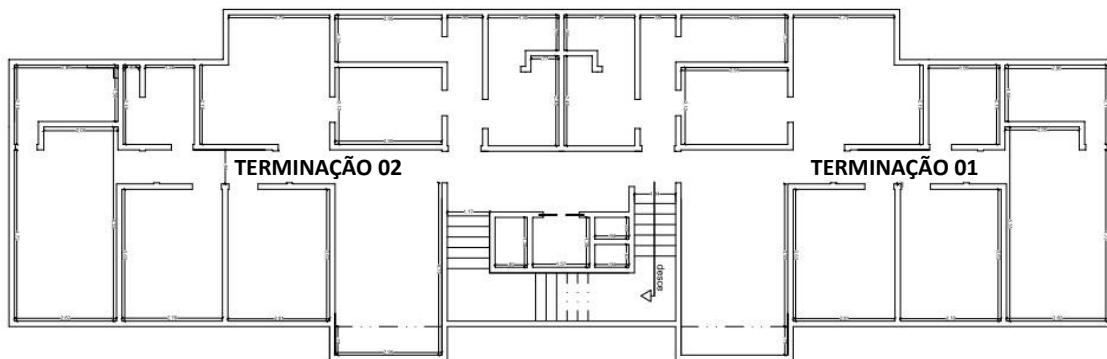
Planta Baixa (croqui) – Pavimento 6 - Blocos A, B e C.
